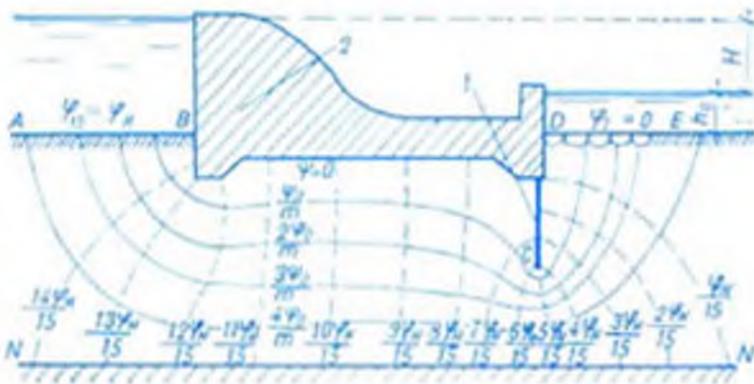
Линии равных напоров. Гидрометрическая сетка под бетонной водосливной плотиной: 1 — шпунт; 2 — зуб плотины; H — напор воды; h_1 — глубина воды в нижнем бьефе.
